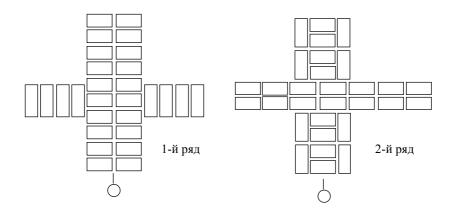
Кладка пересечений стен толщиной в 1,5 и 1 кирпич
